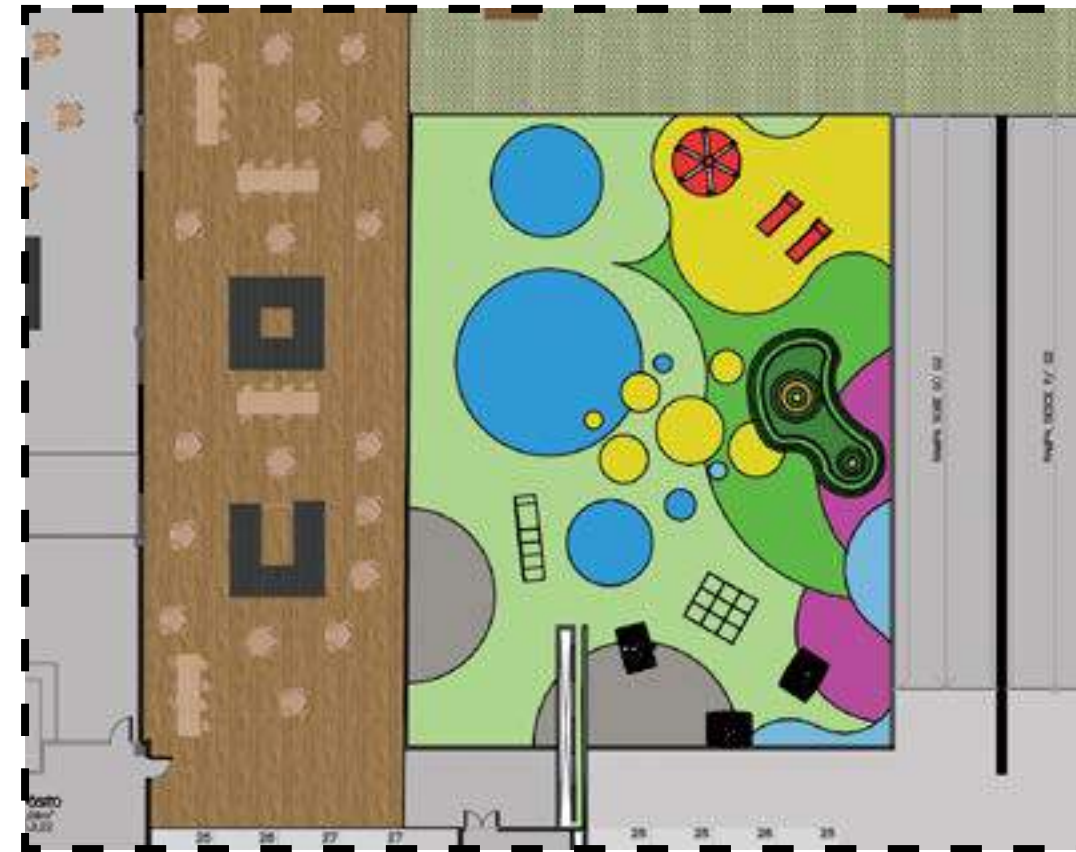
PLANTA BAIXA- ÁREA INFANTIL
